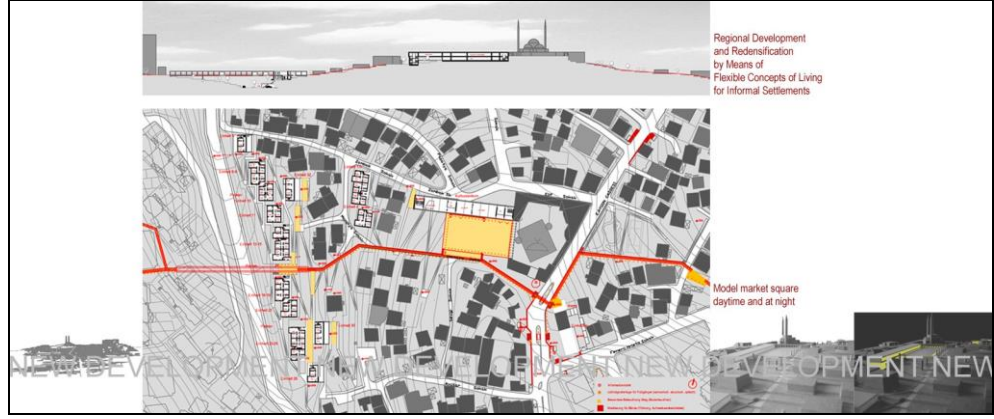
Karanfilköy Vaziyet Planı, Yıldırım A. B..
